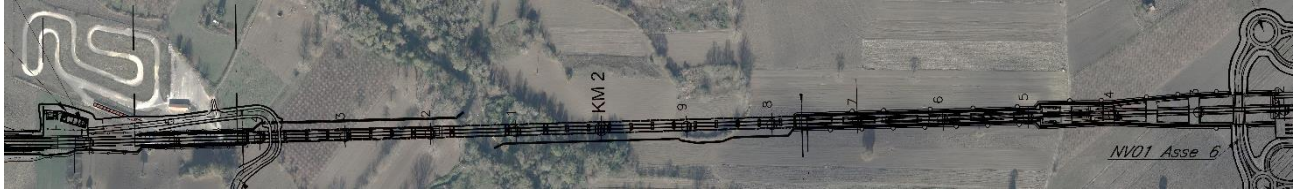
Planimetria con indicazione delle tratte in rilevato scatolare e viadotto Ufita-Hirpinia
